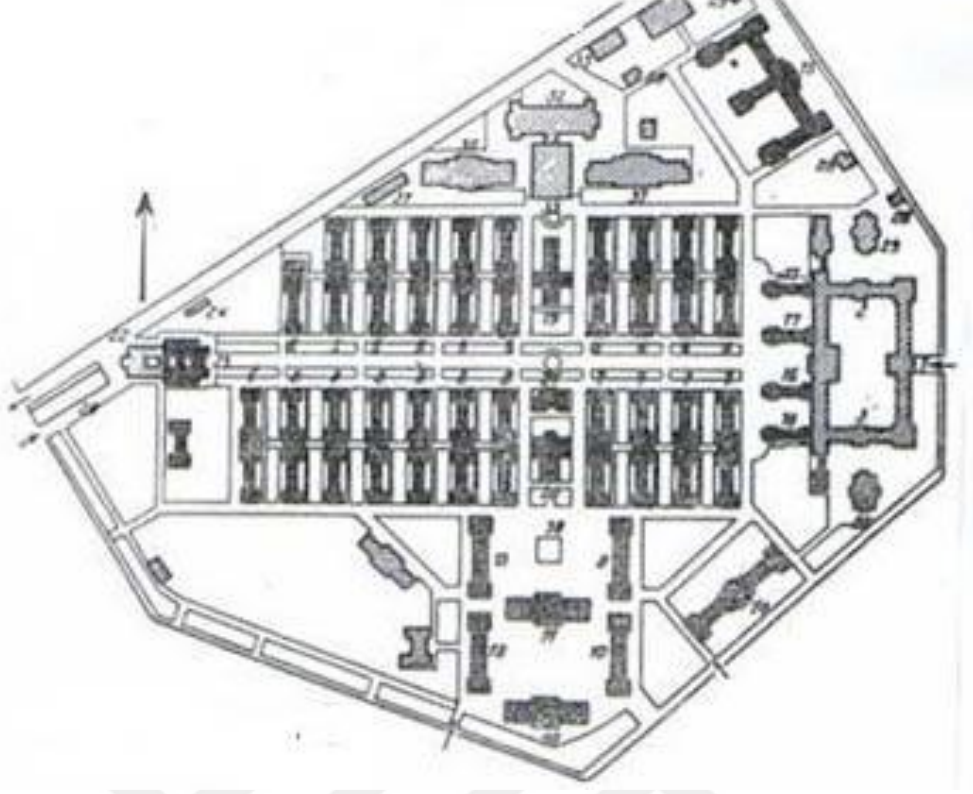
Sultan Ahmet Darüşşifası planı
